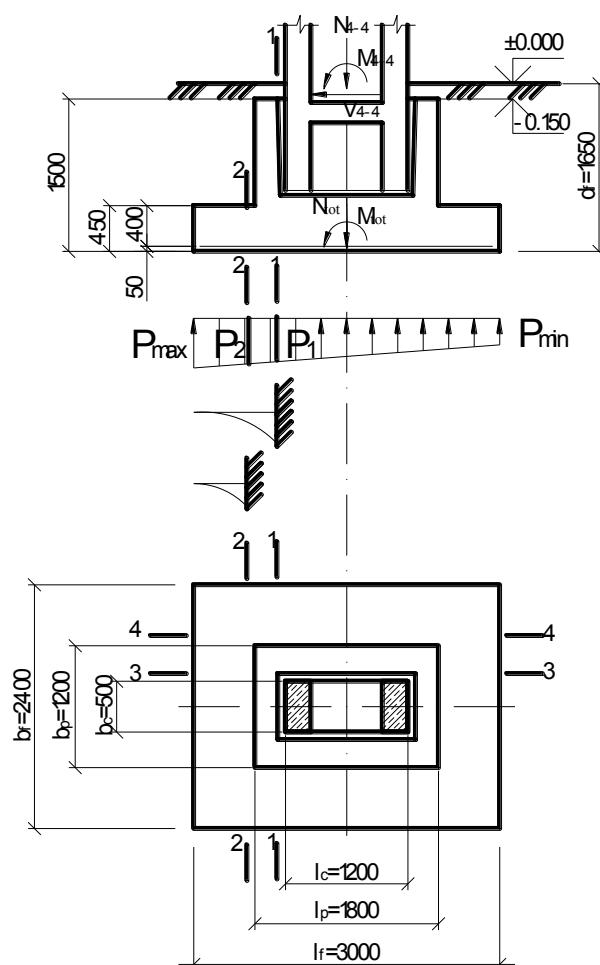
Расчетные схемы плитной части фундамента
